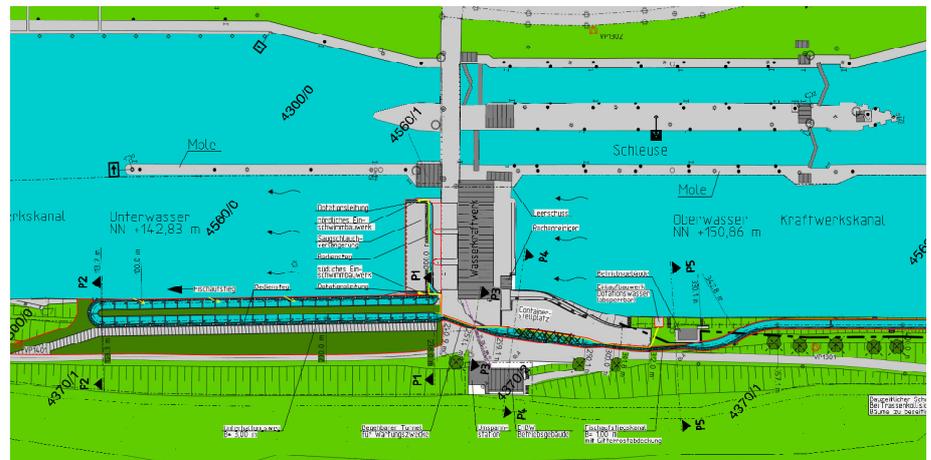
Planausschnitt Lageplan Variante 2 – Vorplanung (Stand Oktober 2011)
